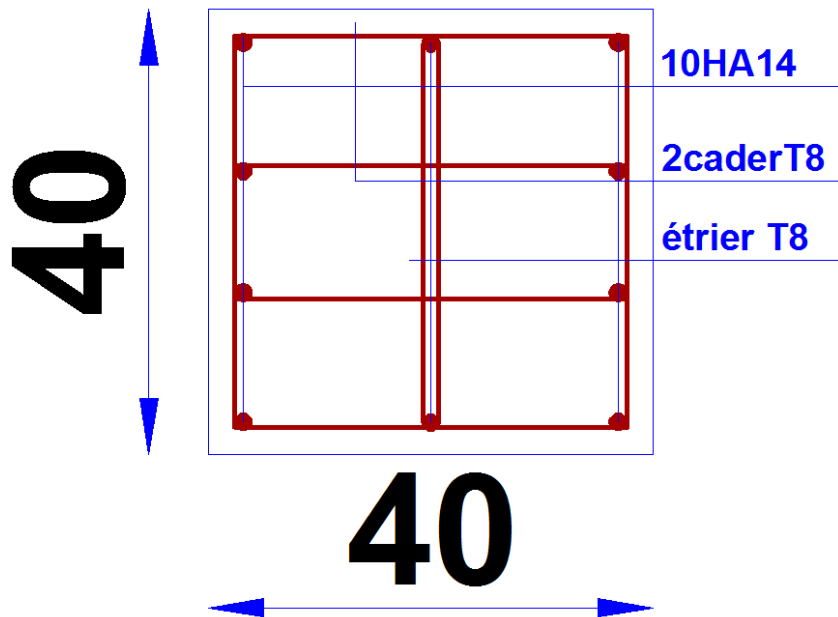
Schéma de ferrailage des poteaux 40×40 solidaires aux voiles
